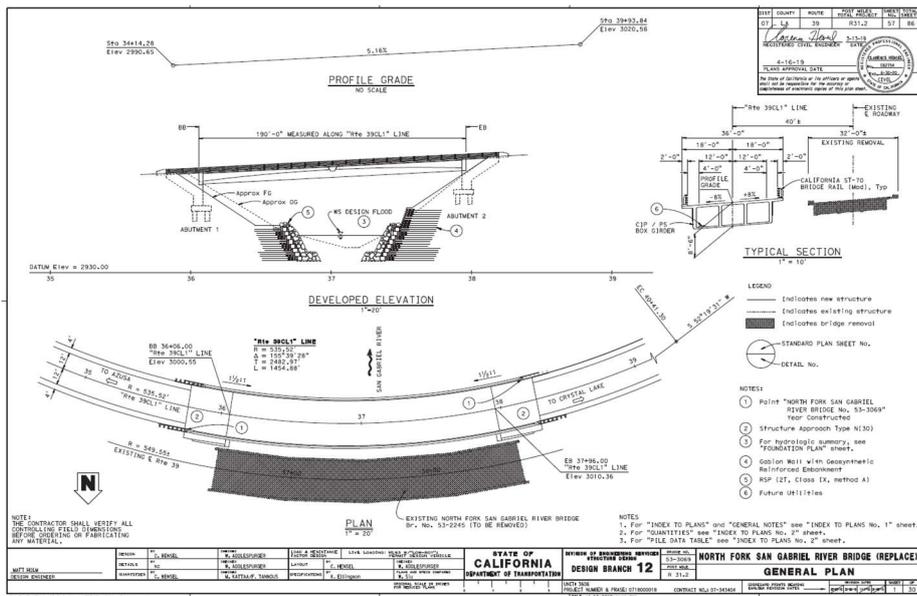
North Fork San Gabriel River Bridge 新橋與河道剖面圖及新橋平面圖
